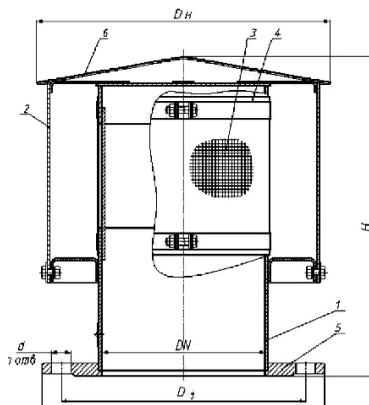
Вентиляционный патрубок: 1 – корпус; 2 – кожух; 3 – сетка; 4 – хомут; 5 – присоединительный фланец; 6 – крышка
